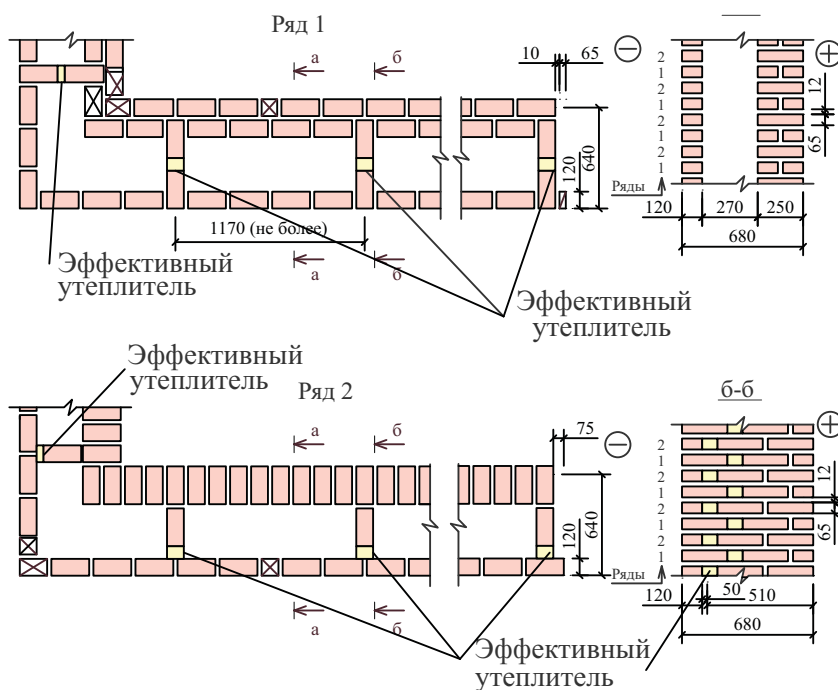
Наружная стена из кирпичной кладки с вертикальными кирпичными диафрагмами с самонесущим внутренним слоем (тип КД-2). Сечение 19-19
